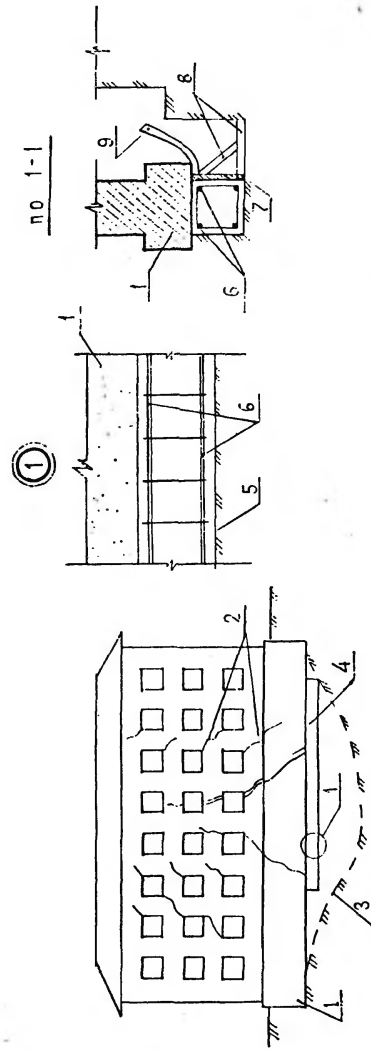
Разгрузка ослабленной части фундамента устройством в основании железобетонного пояса
